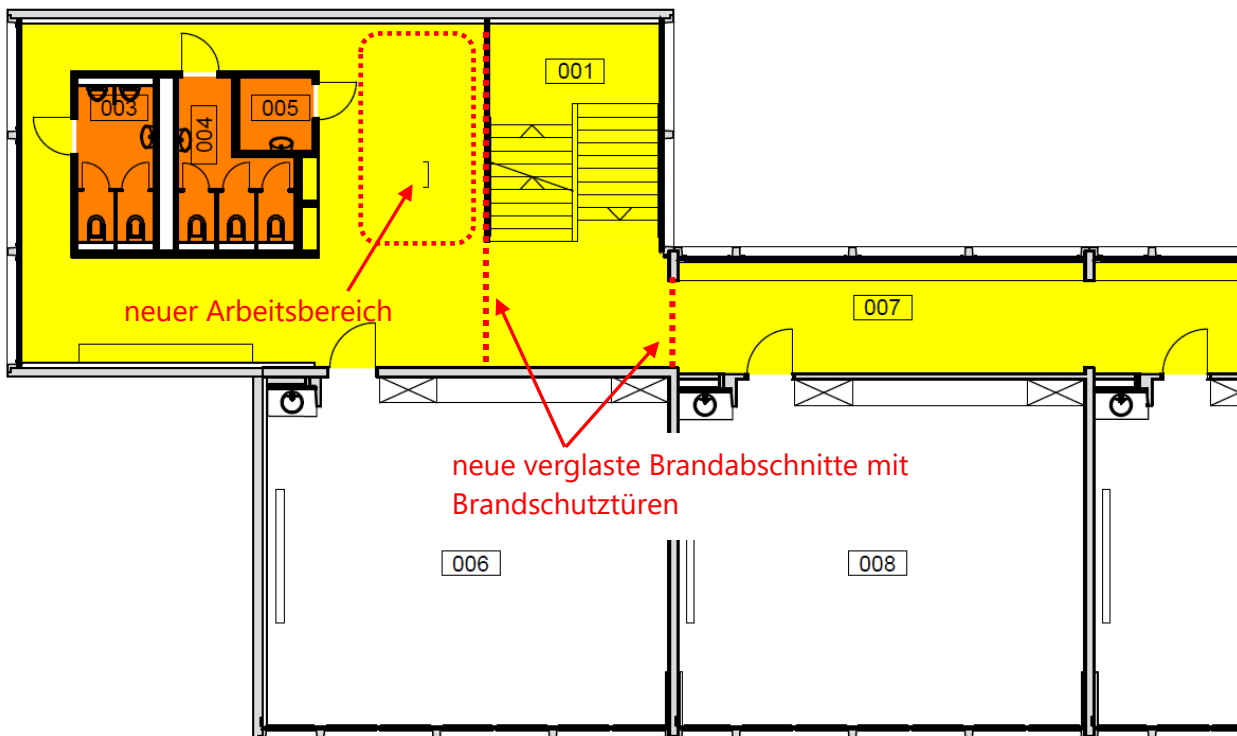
Grundrissausschnitt OG Klassentrakt 1 - Soll
